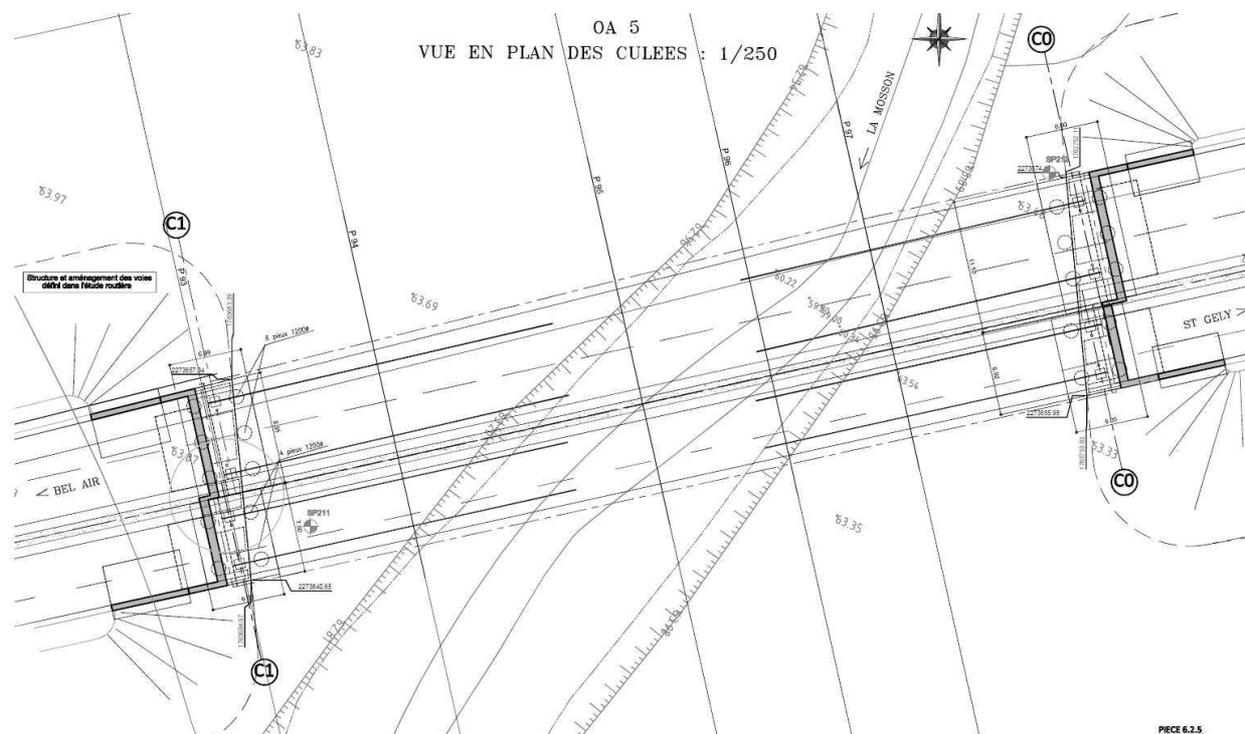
Plan de l'ouvrage de franchissement de la Mosson (source : CD34)
